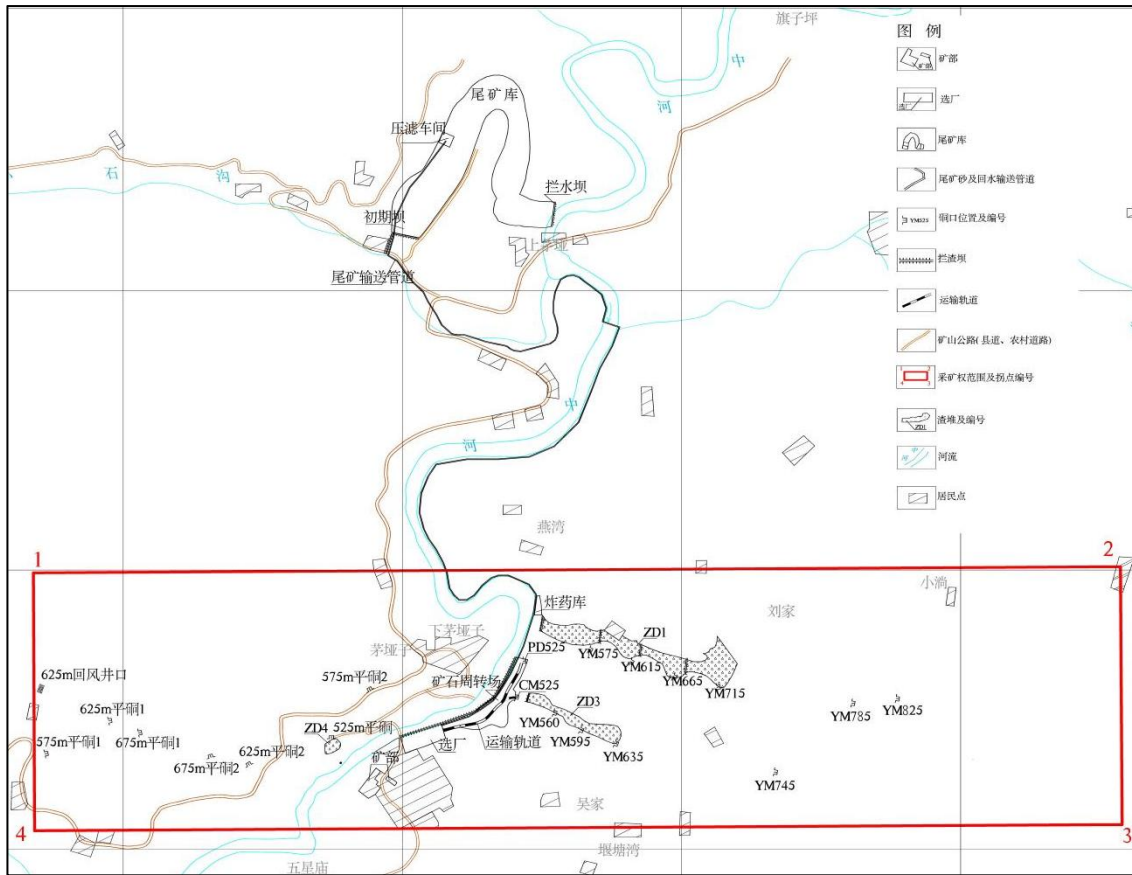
鹿鸣金矿矿山工程平面布置示意图
